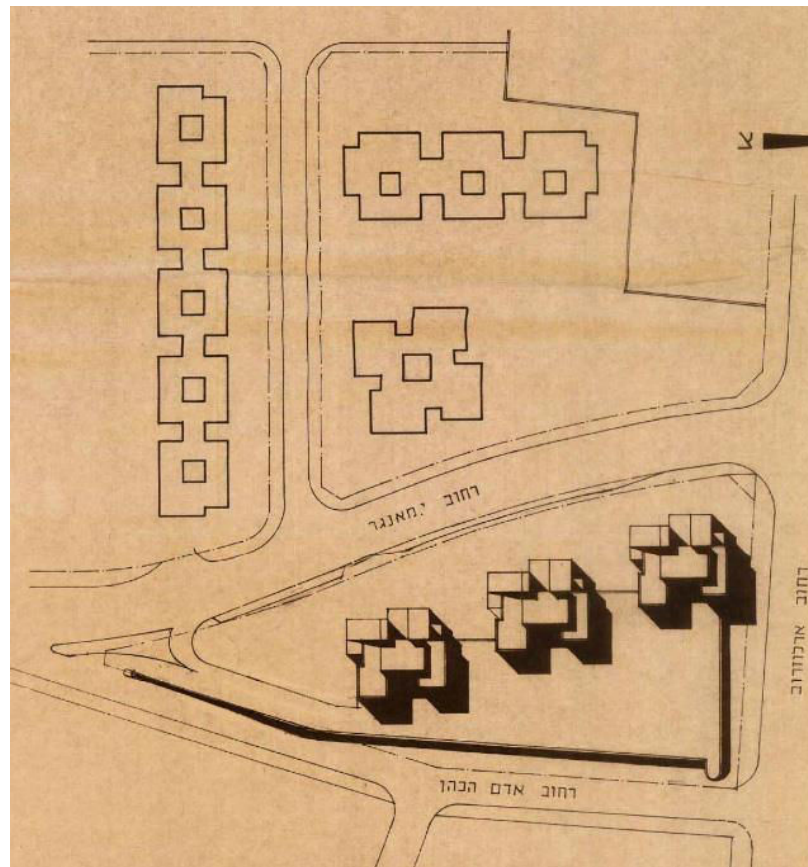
Plan de position, extrait du permis de construire d'origine : ADCTJ
